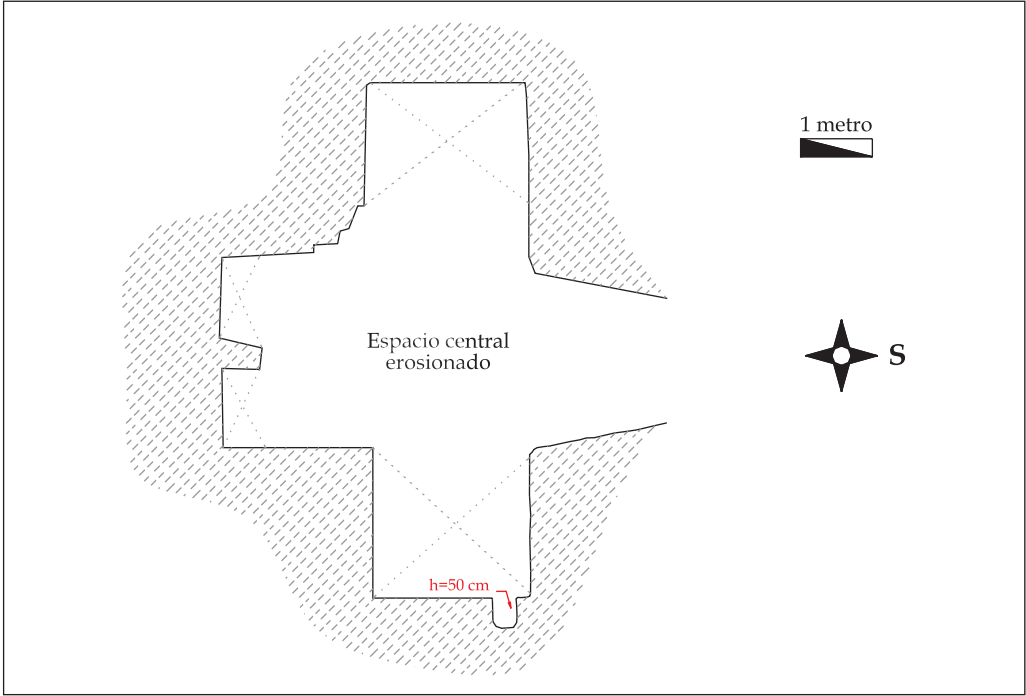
Planta del hipogeo QH/4. Tipo 3
